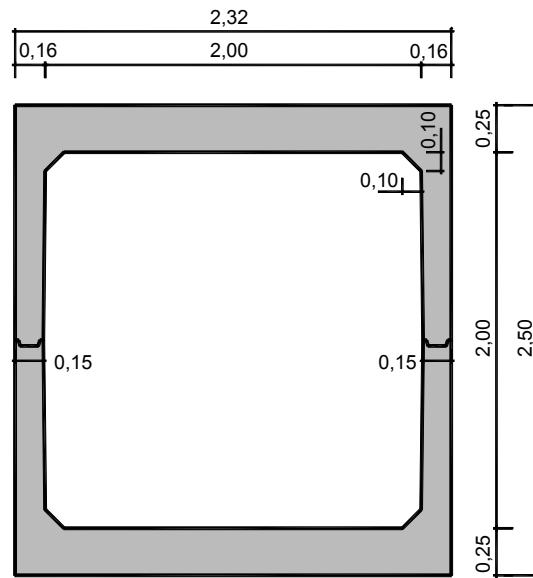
Dimensões da secção transversal da box-culvert.
